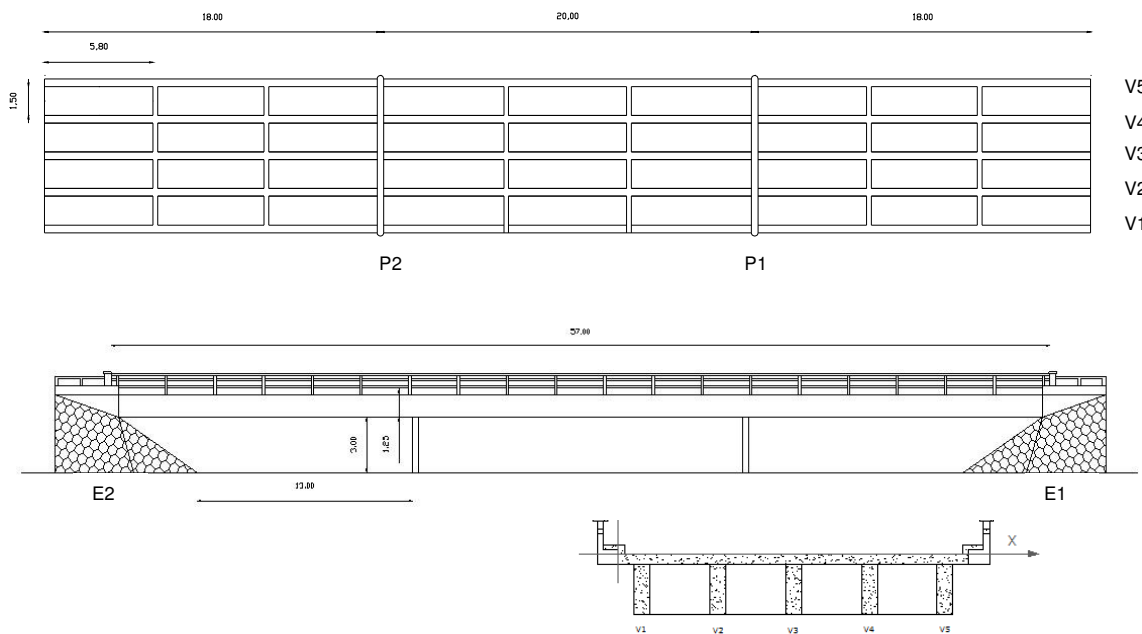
Croquis de la vista inferior, lateral y transversal del puente donde se nombran los estribos y pilas.
